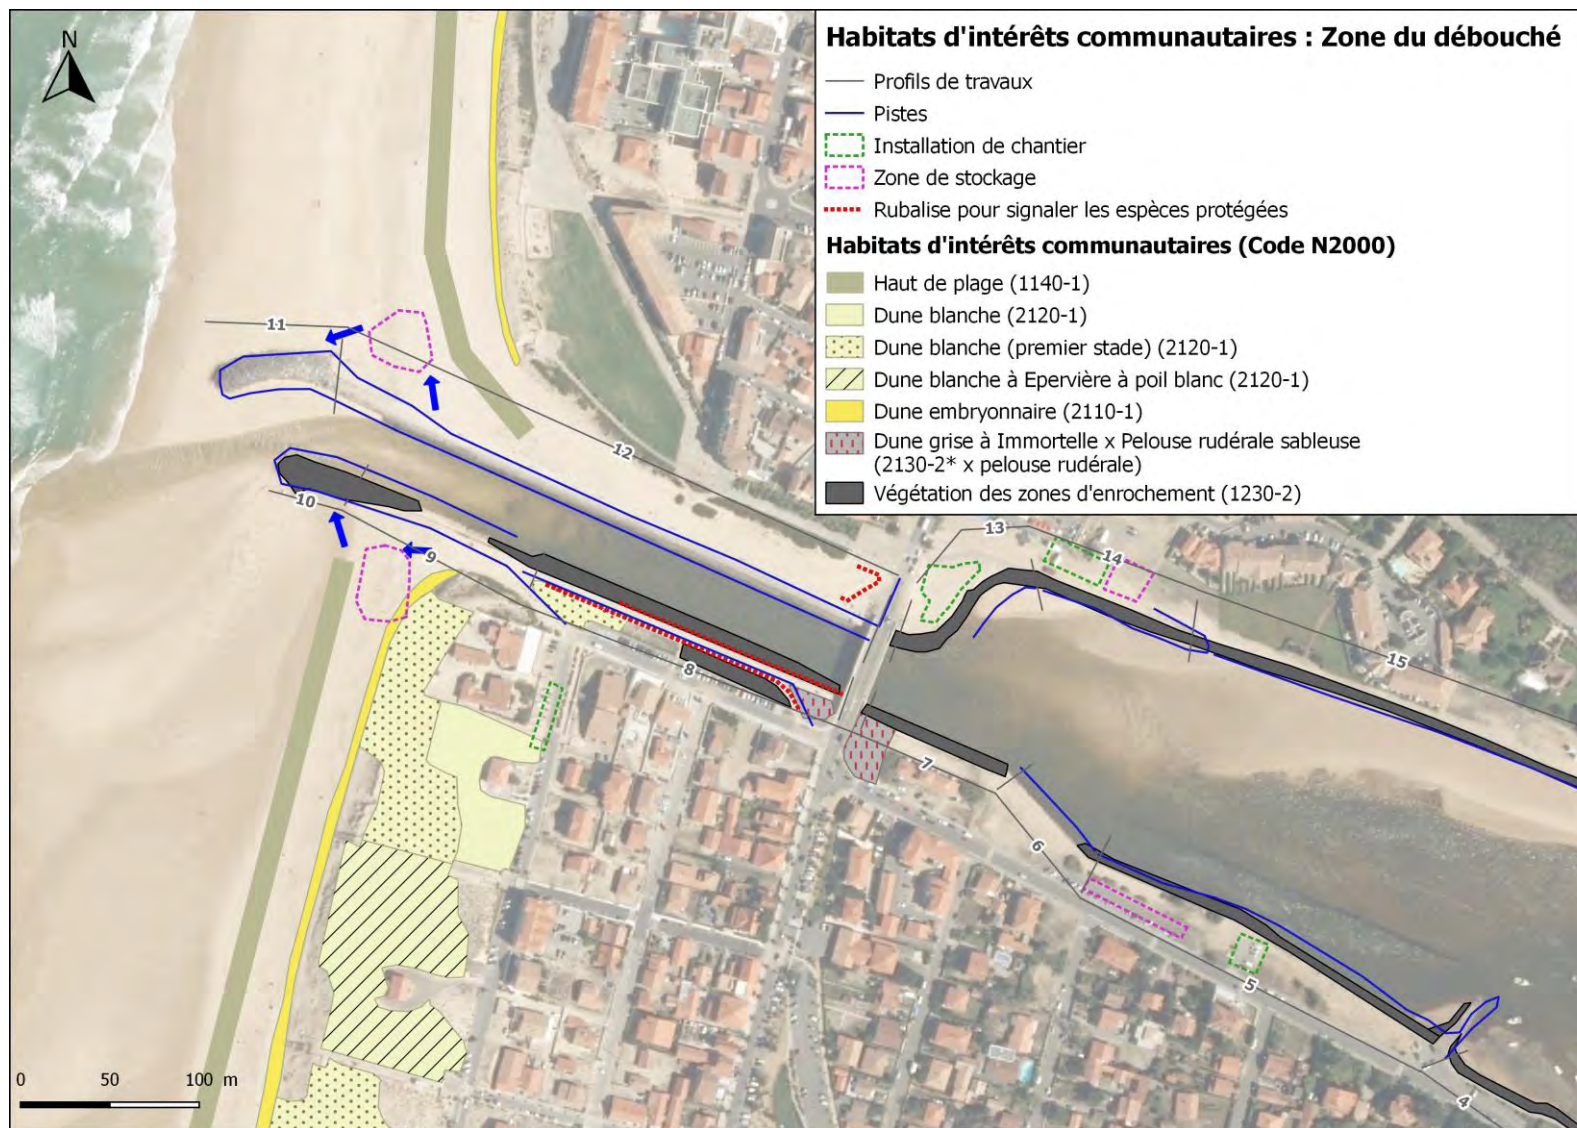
Dispositions constructives et habitats d'intérêt communautaire en lien avec les travaux de confortement sur les ouvrages du débouché
